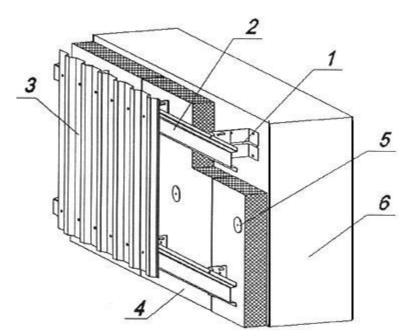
Конструкция НВФС с горизонтальной схемой расположения направляющих и облицовкой из профилированных листов 1 - кронштейн составной; 2 - профиль шляпный 23 (60); 3 - профилированный лист; 4 - утеплитель; 5 - упор дюбельный для крепления утеплителя; 6 - стена.
